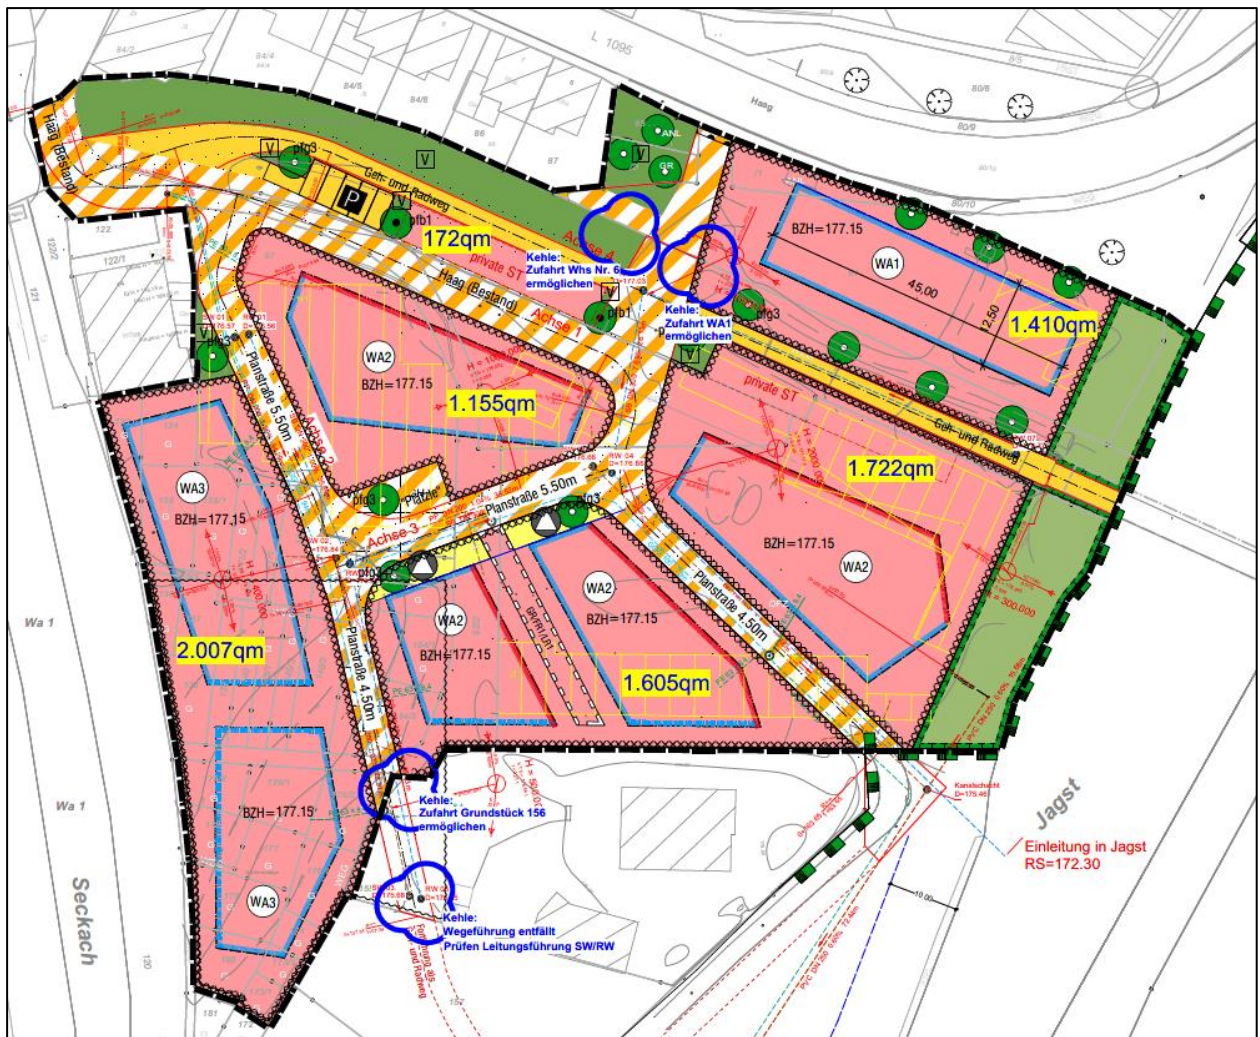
Ausschnitt Bebauungsplan „Im Haag“⁴
